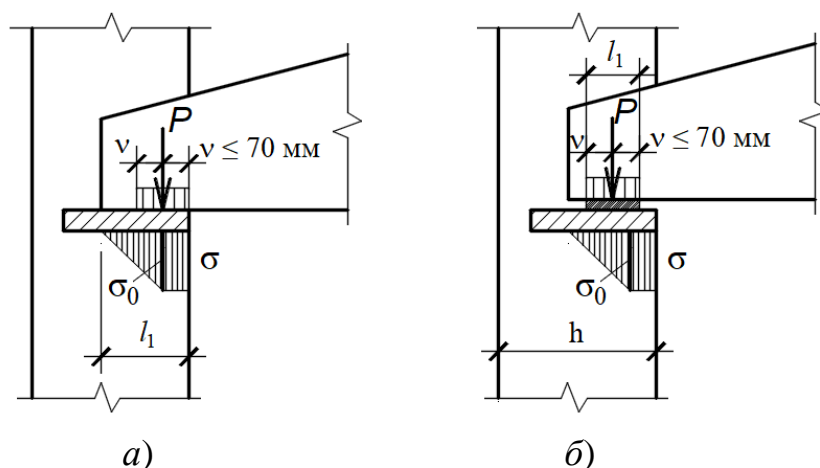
Схема навантаження і напруження при розрахунку розподільної плити:
